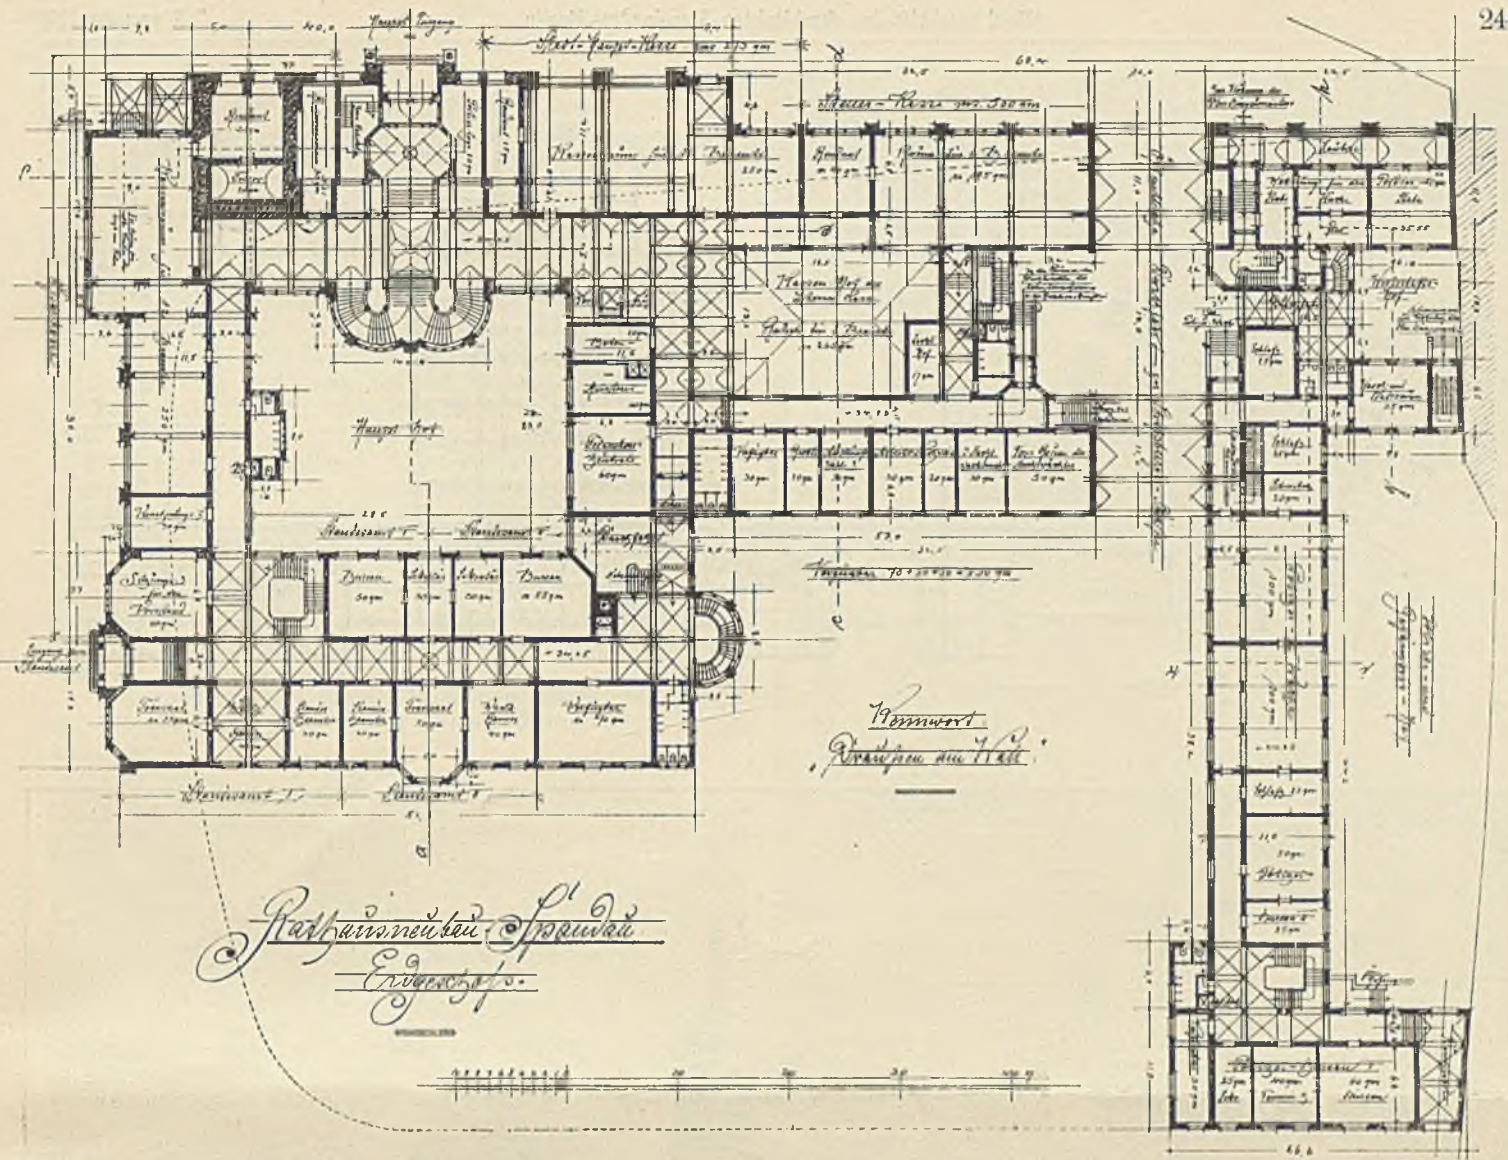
Kennwort: „Draußen am Wall“. Verfasser: Landbauinspektor Conrad Dammeier in Schöneberg
